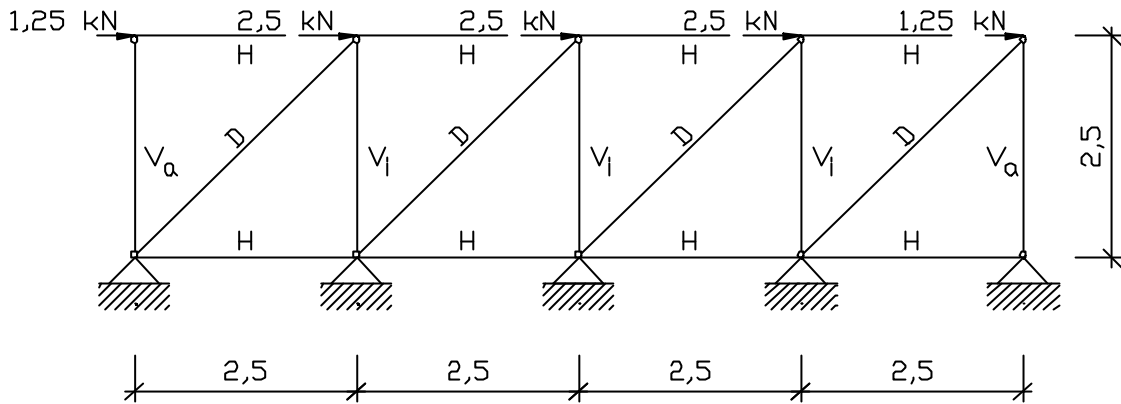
Ersatzmodell für Brettlagenholz mit diagonaler Struktur
